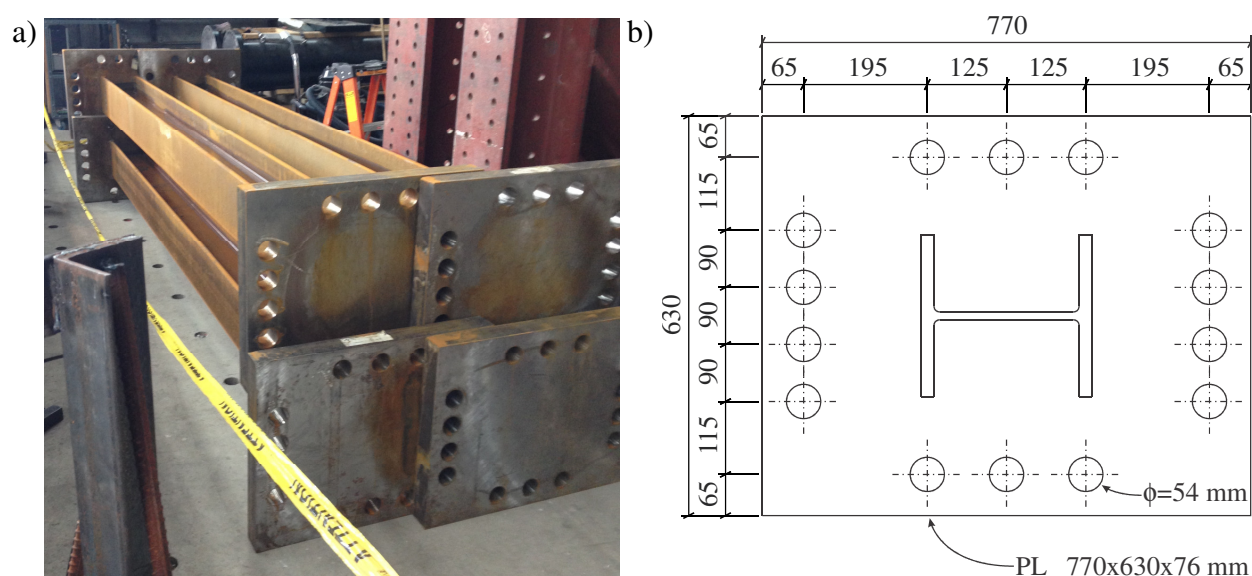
Colonnes d'acier testées : a) vue isométrique ; b) dimensions des plaques d'extrémités (mm).
